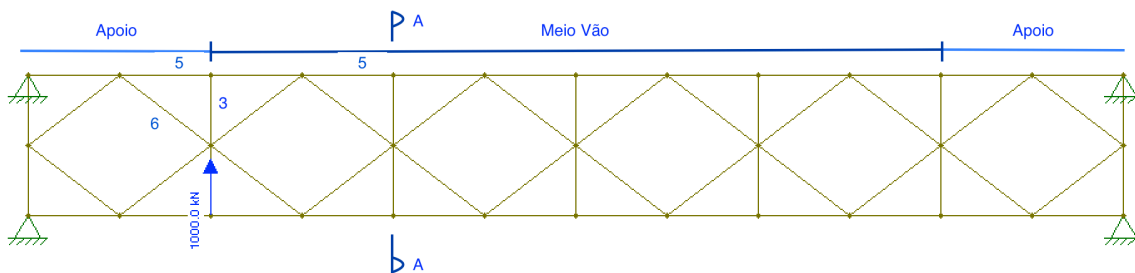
Modelo de simulação da treliça rígida ao nível do banzo inferior do contraventamento em planta
